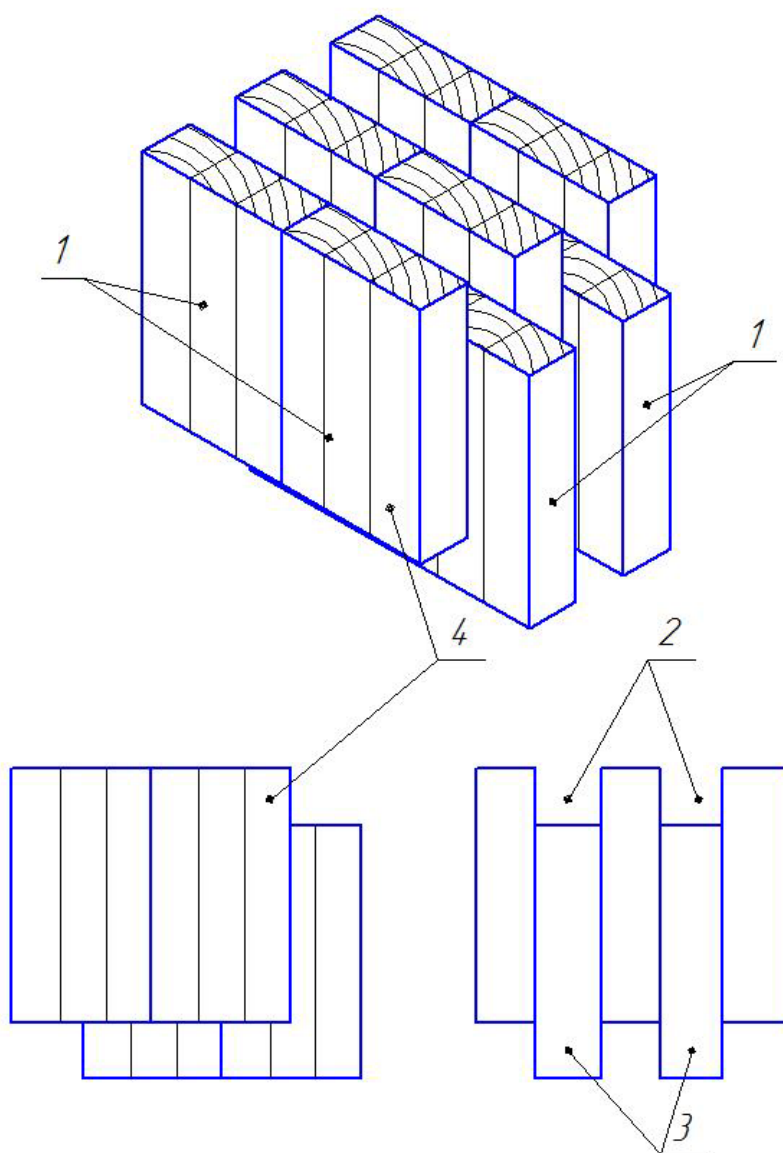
Предлагаемый строительный блок: а – общий вид; б – вид спереди; в – вид сбоку; 1 – доска; 2 – паз; 3 – шип; 4 – брусок
